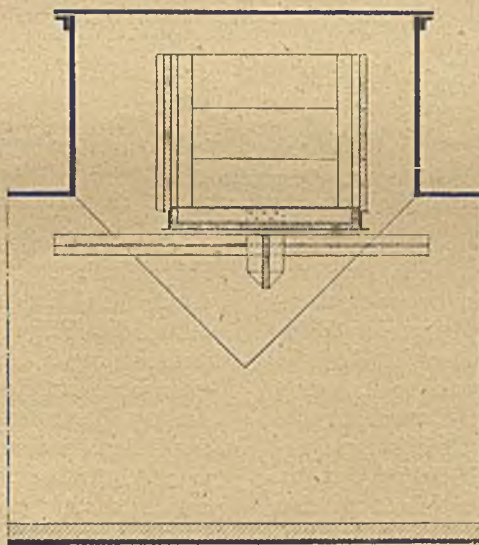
Längsschnitt durch die Versuchsstrecke mit eingebautem Gesteinstaubbruch nach Bauart a.
